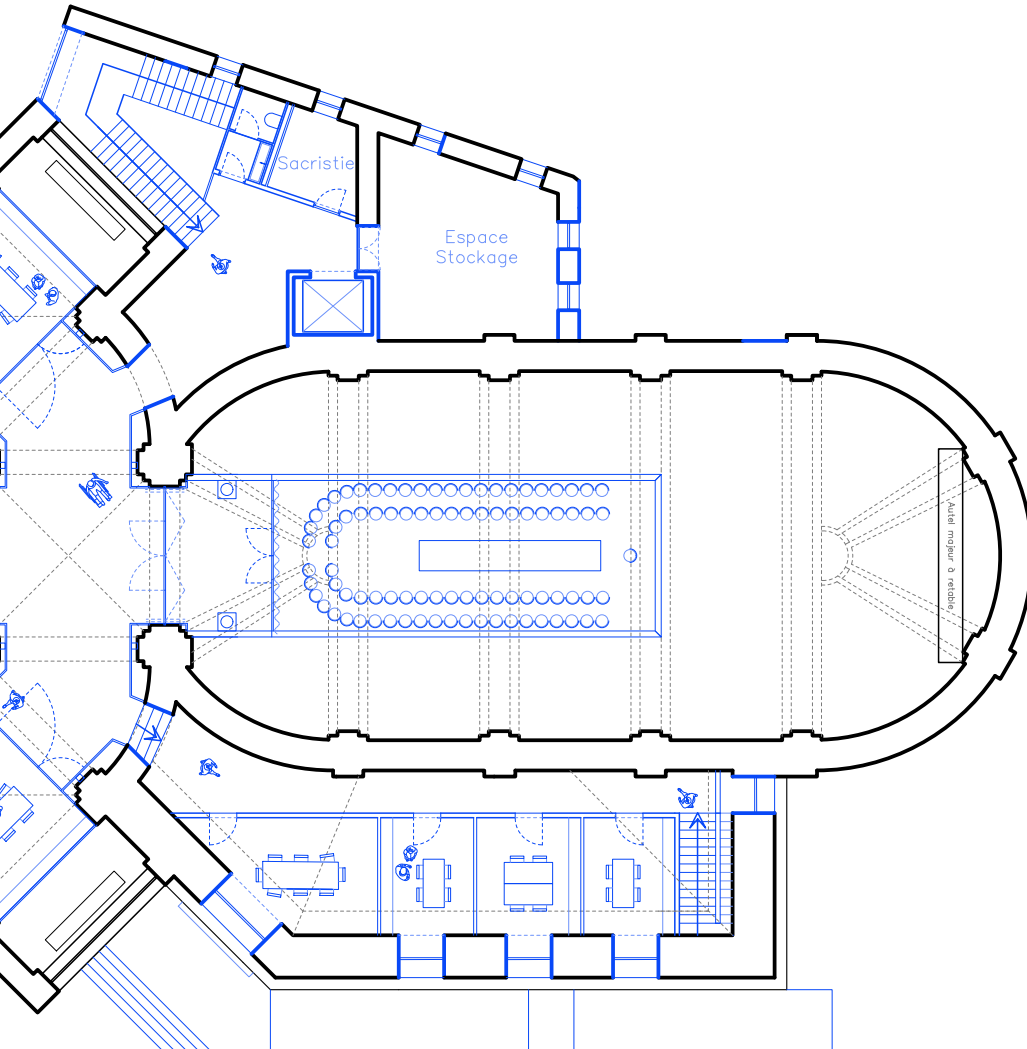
Situation projetée - Plan du Rez +1, 1/250°
